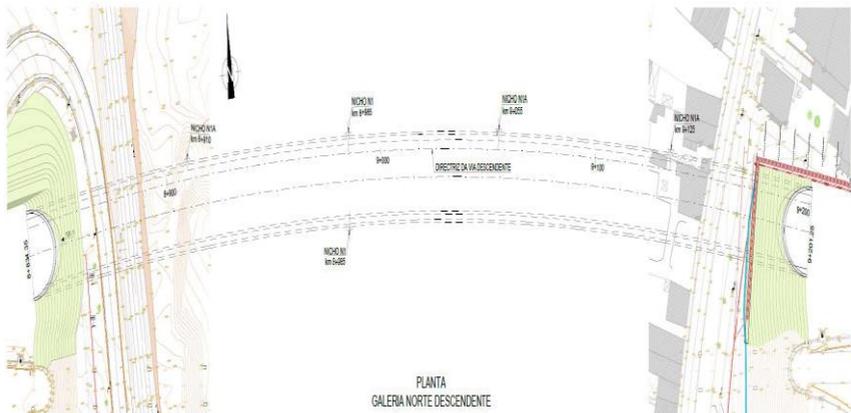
Planta do novo Túnel de Águas Santas (Fonte: Projeto de construção)
